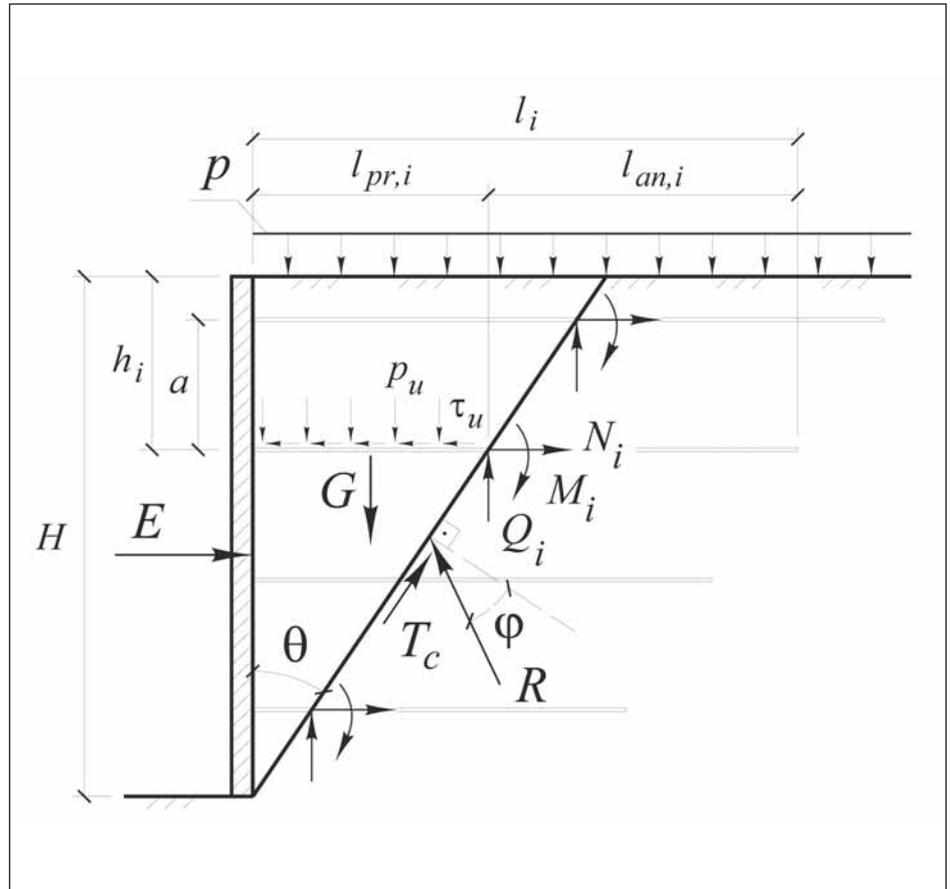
Расчетная схема вертикального откоса, армированного горизонтальными стержнями
